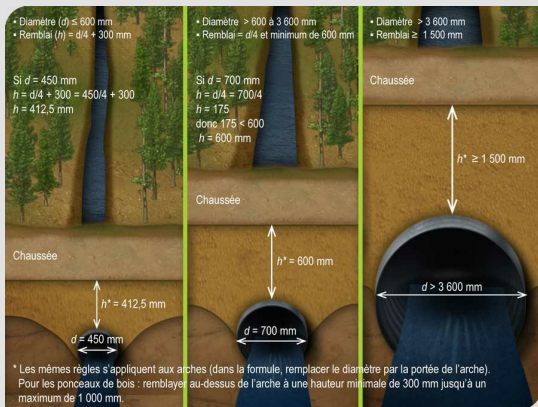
B Épaisseur minimale du remblai au-dessus d'un conduit ou d'une arche en fonction de son diamètre ou de sa portée
